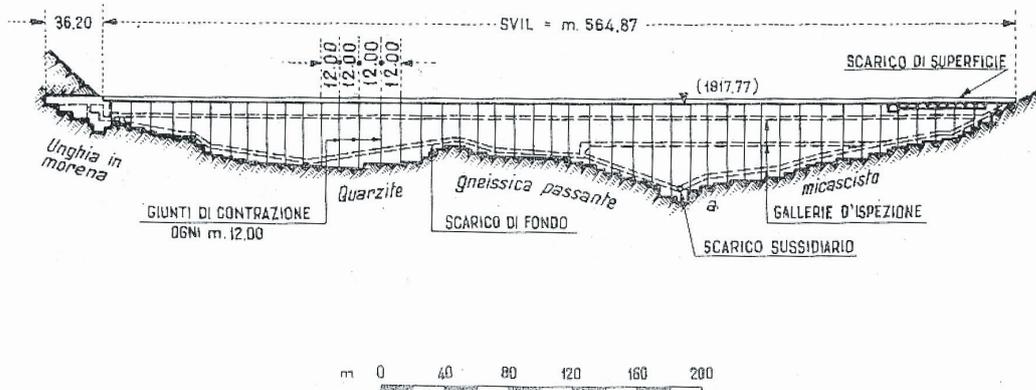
Planimetria e sezioni longitudinali diga di Morasco
